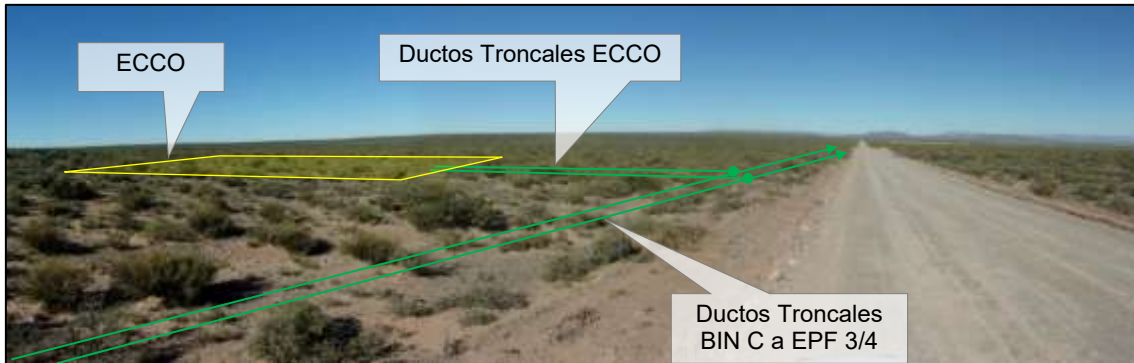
Vista en dirección Oeste. Se observan las trazas de los ductos Troncales BIN C a EPF 3/4 paralelas al camino existente. Además se señala la Estación de Control-BIN C Oeste (ECCO, presentado en adenda "Campamento habitacional y sistema de control BIN C") y las trazas de los ductos Troncales ECCO (16"-ECCO-DuctoBIN C a EPF 3/4-4024 y 16"-ECCO-DuctoBIN C a EPF 3/4-4025). Coordenadas x: 5833318; y: 2486659.
